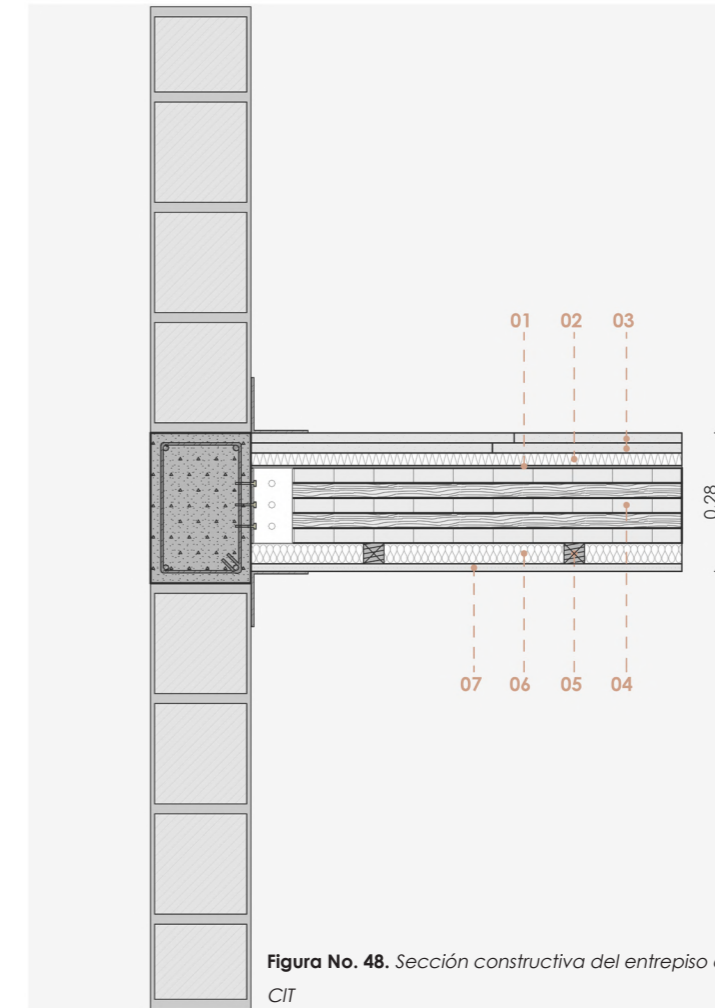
Sección constructiva del entresijo con paneles de CLT
